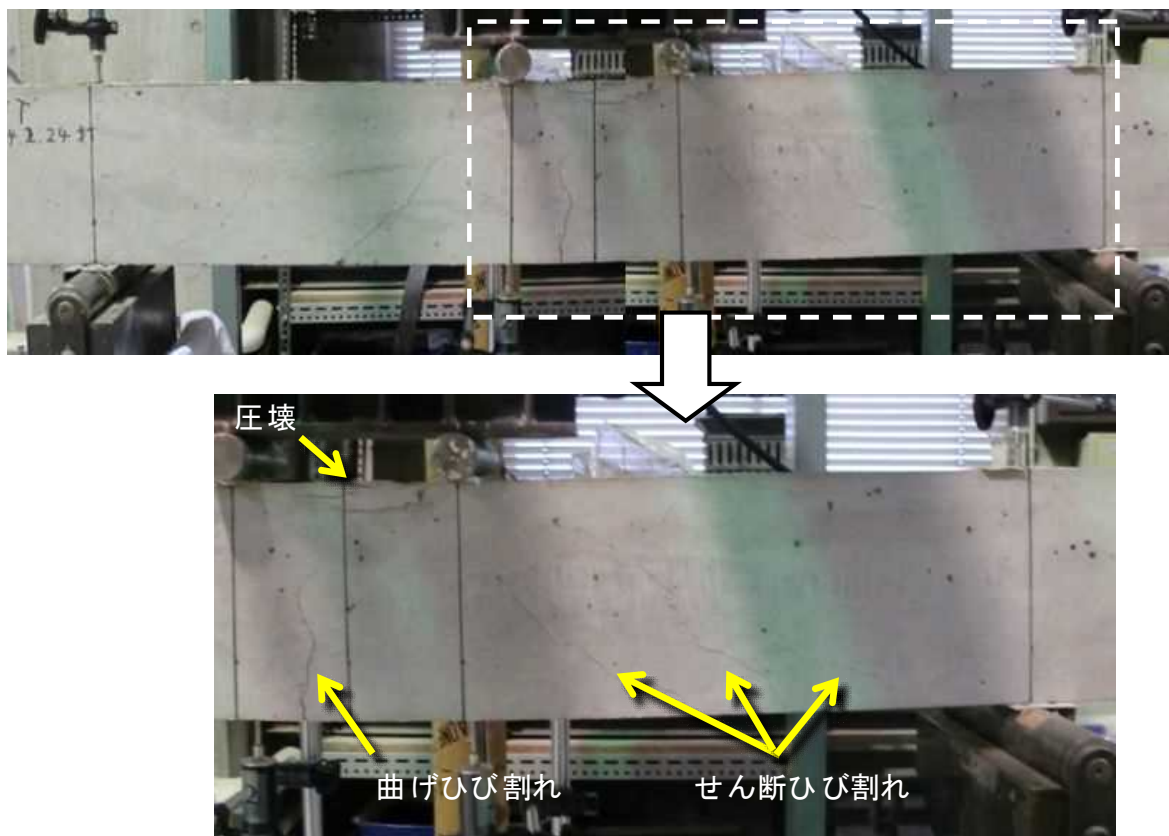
No. 2 (せん断補強) 曲げ破壊状況
